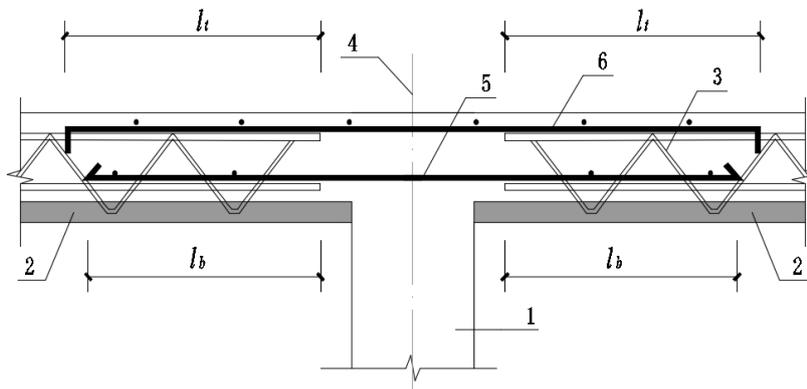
钢筋桁架保温混凝土板中间节点支座构造示意
